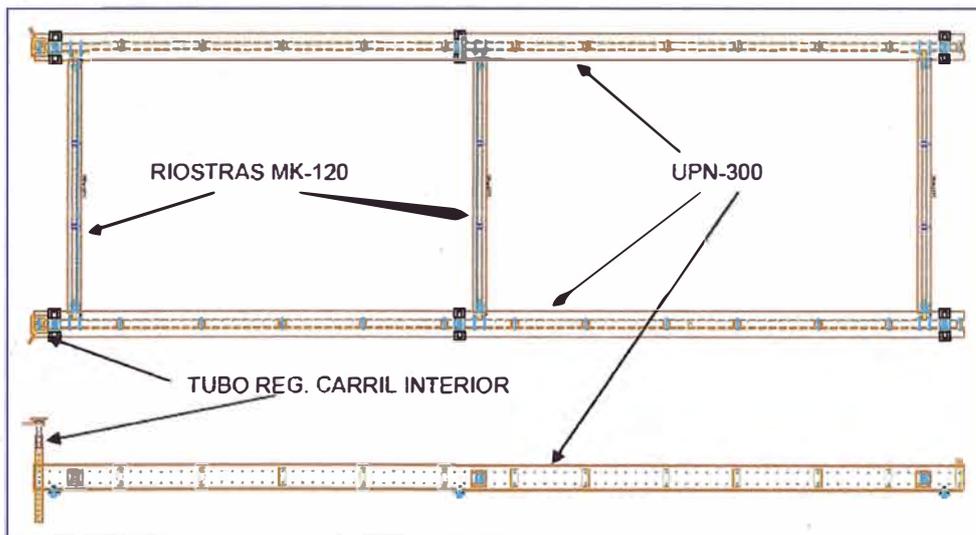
Vista planta y elevación de carriles de desplazamiento - Fuente: Elaboración Propia
